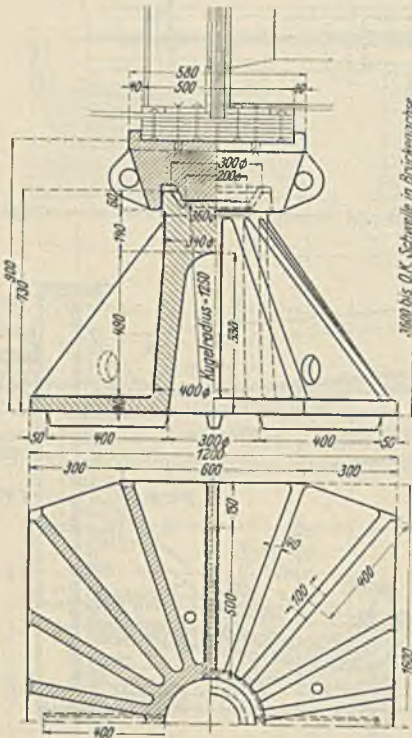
Festes Lager mit Aufriß und Grundriß samt oberem Kopfstück (für 510 t).
